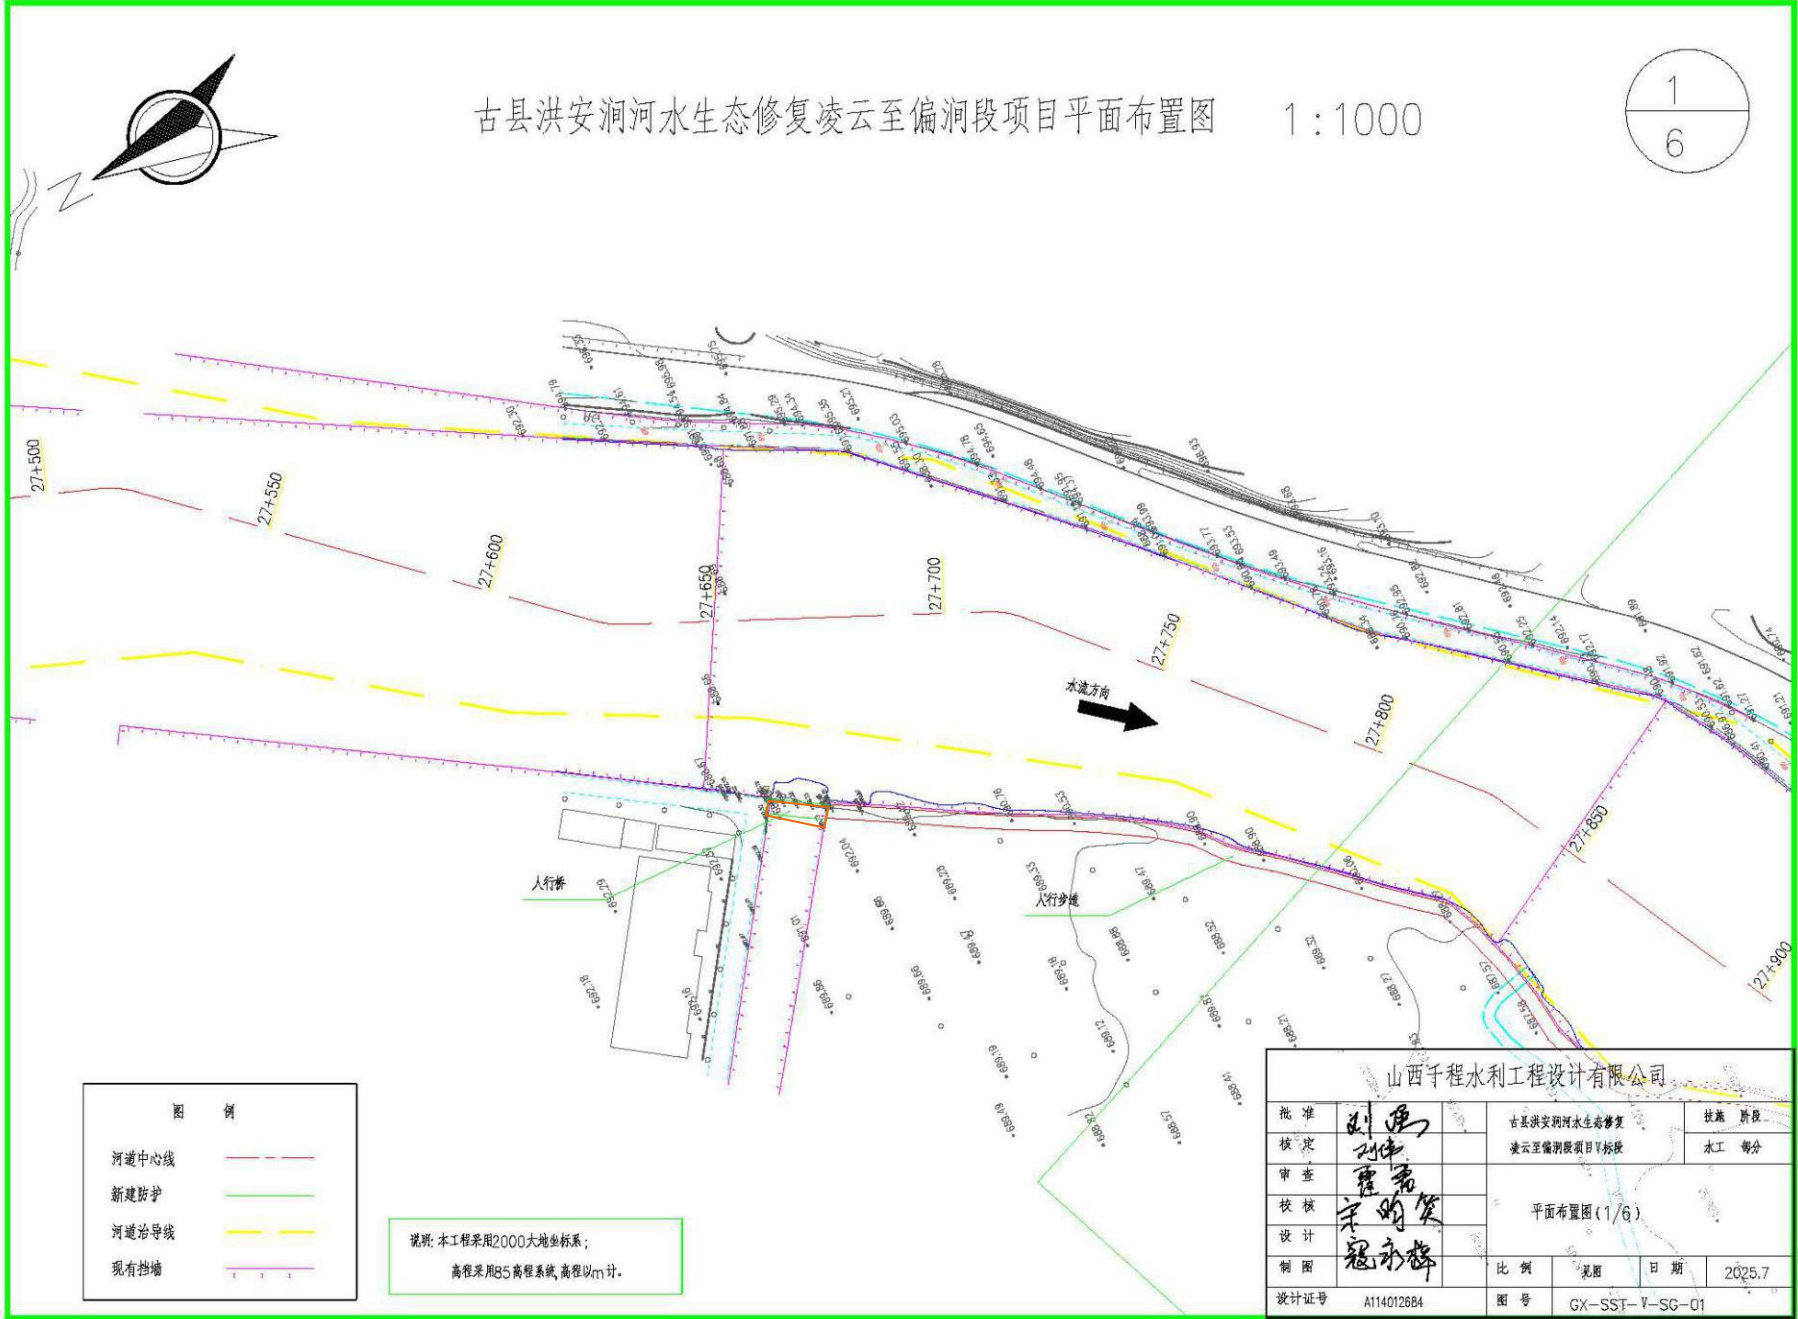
(14) 工程总平面布置图 (桩号 27+400-27+900)
